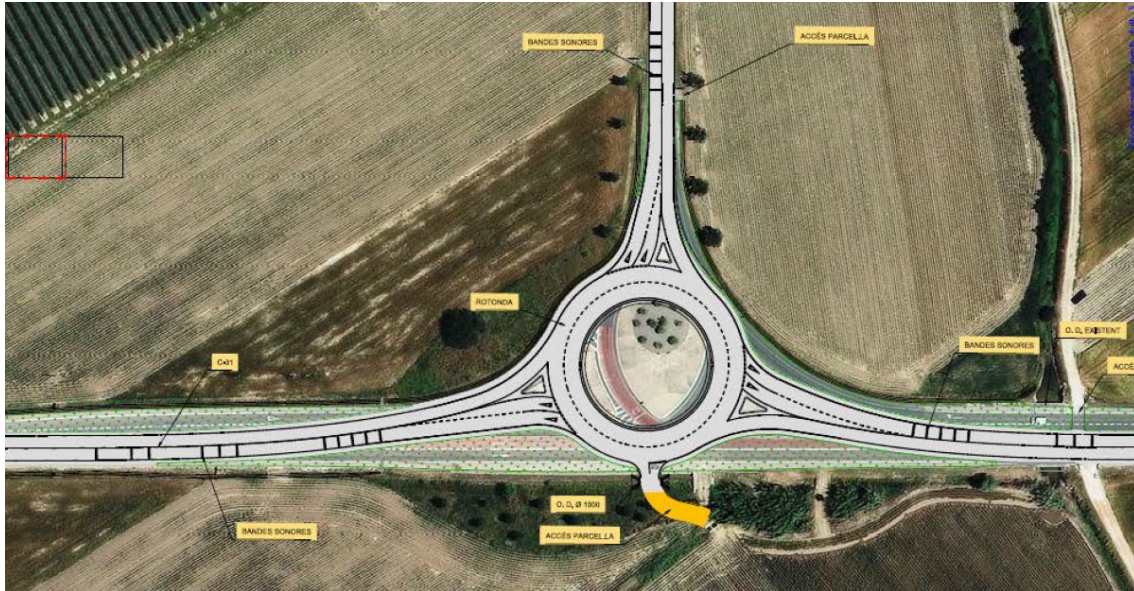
Planta de la rotonda del projecte sobre ortofoto antiga (Font: Memòria del Departament 2019).
